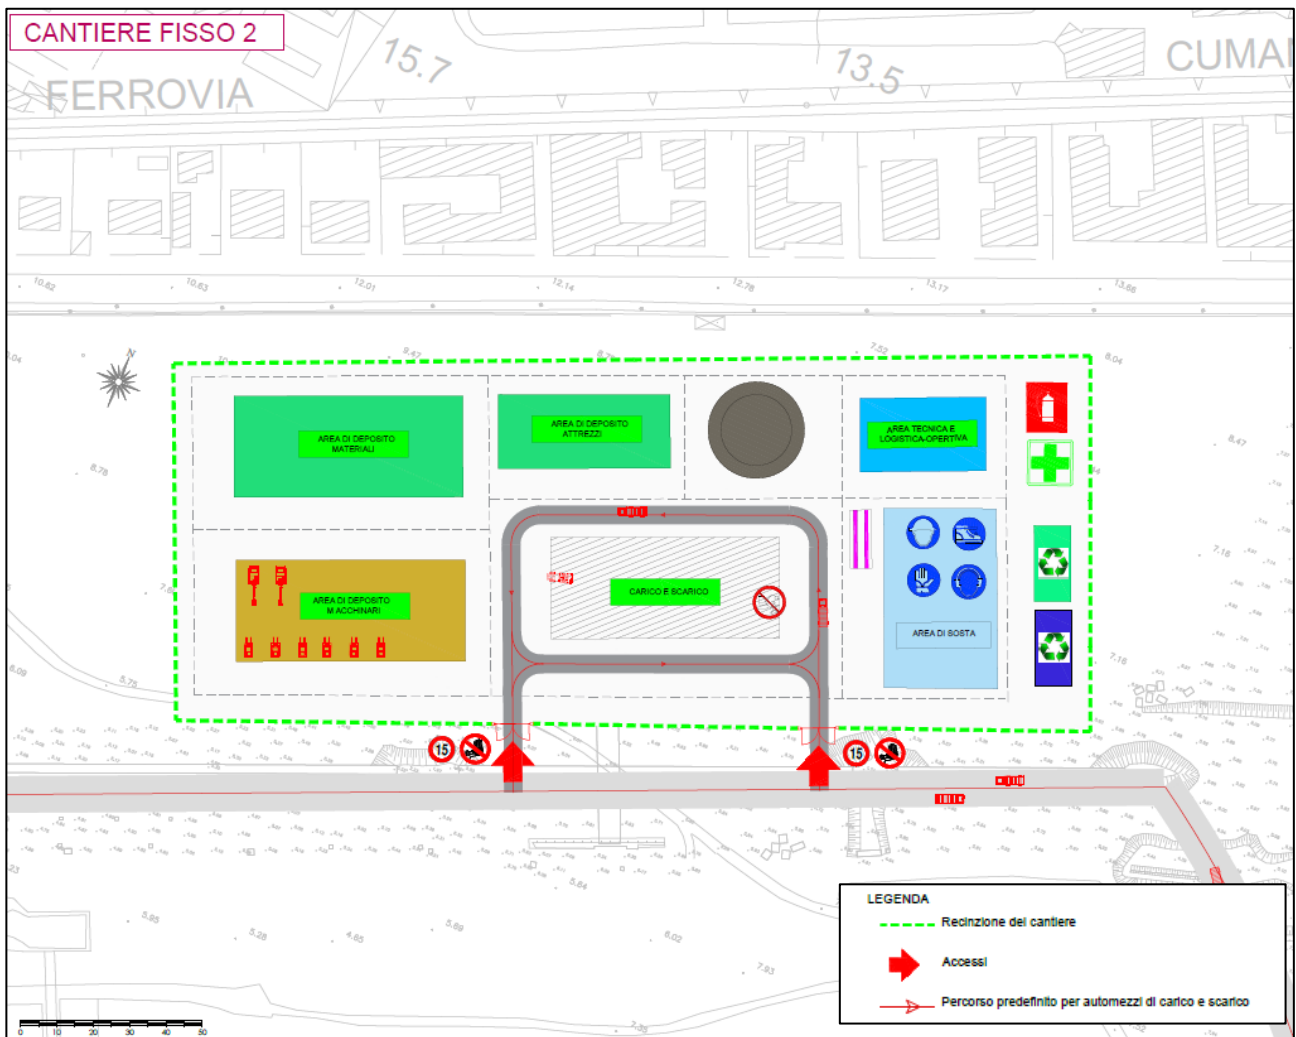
Planimetria Cantiere Fisso 2 (Elaborato: 2021INV-D-PS-PL.10.01.02.01)
